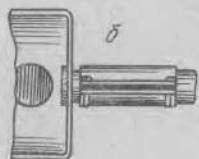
Соединение труб с коробками: а — заземляющей гайкой, б — муфтой на винтах, в — сваркой
